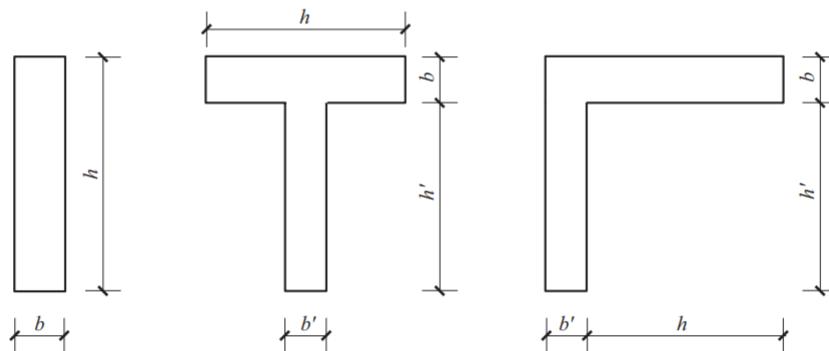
钢筋混凝土矩形柱、T形柱、L形柱尺寸标示图
